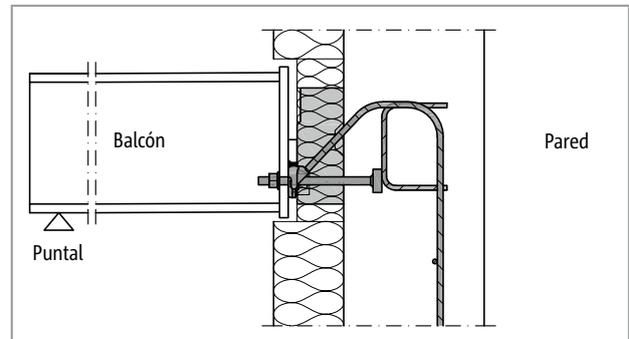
Schöck Isokorb® T tipo SQ-WU: Construcción especial; necesaria en caso de conexión a un muro de hormigón armado con un espesor mínimo de 200 mm
